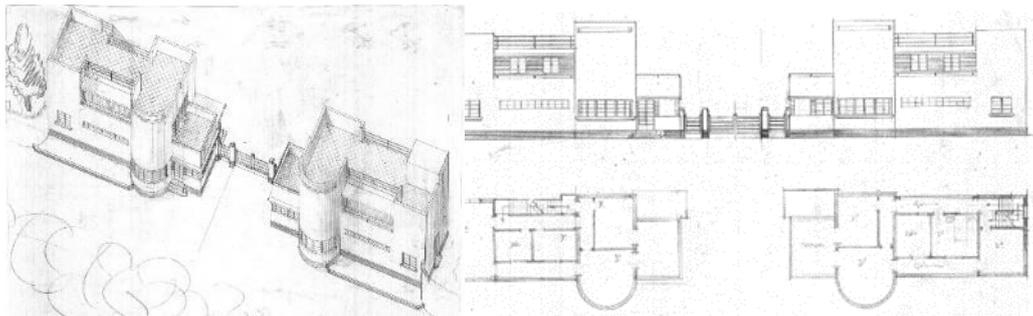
Planos originales de Miguel Martín. Pabellón de acceso.
